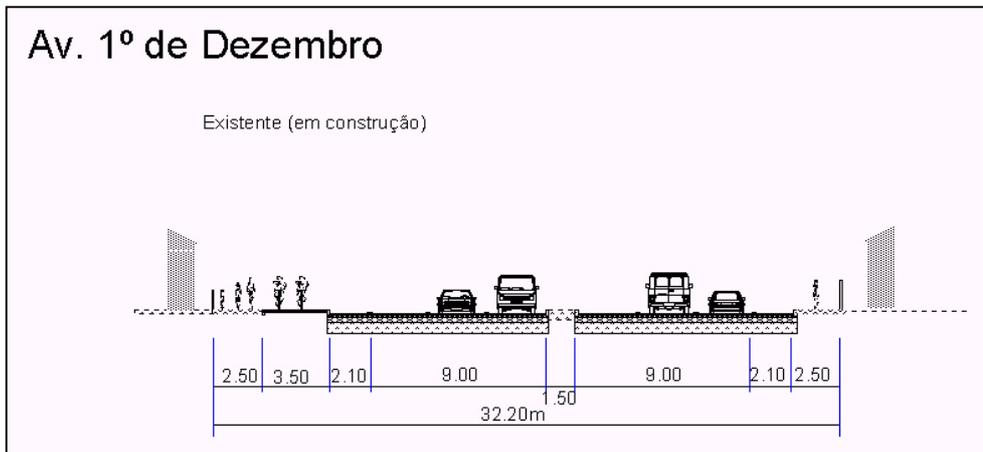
Seção-Tipo do Projeto da Avenida Primeiro de Dezembro
